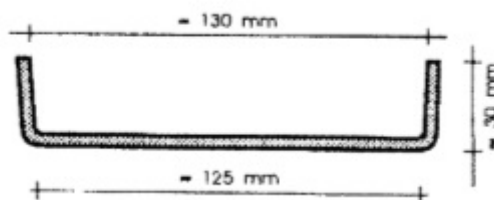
Exemplo de Fôrma para Laje Pré-moldada Tipo Treliça. (Lajes Nervuradas de Concreto armado: Projeto e Execução. BOCCHI JR, 2005.)
